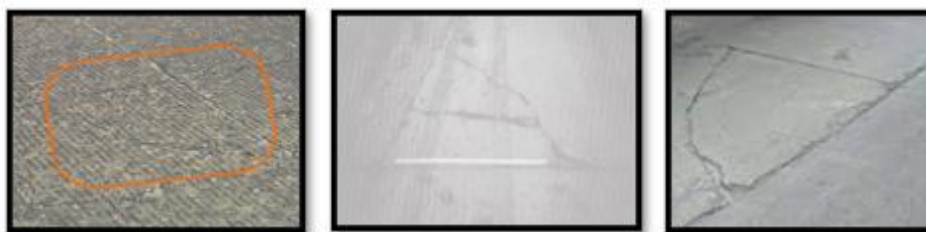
Falla tipo grieta de severidad baja, media, alta.
